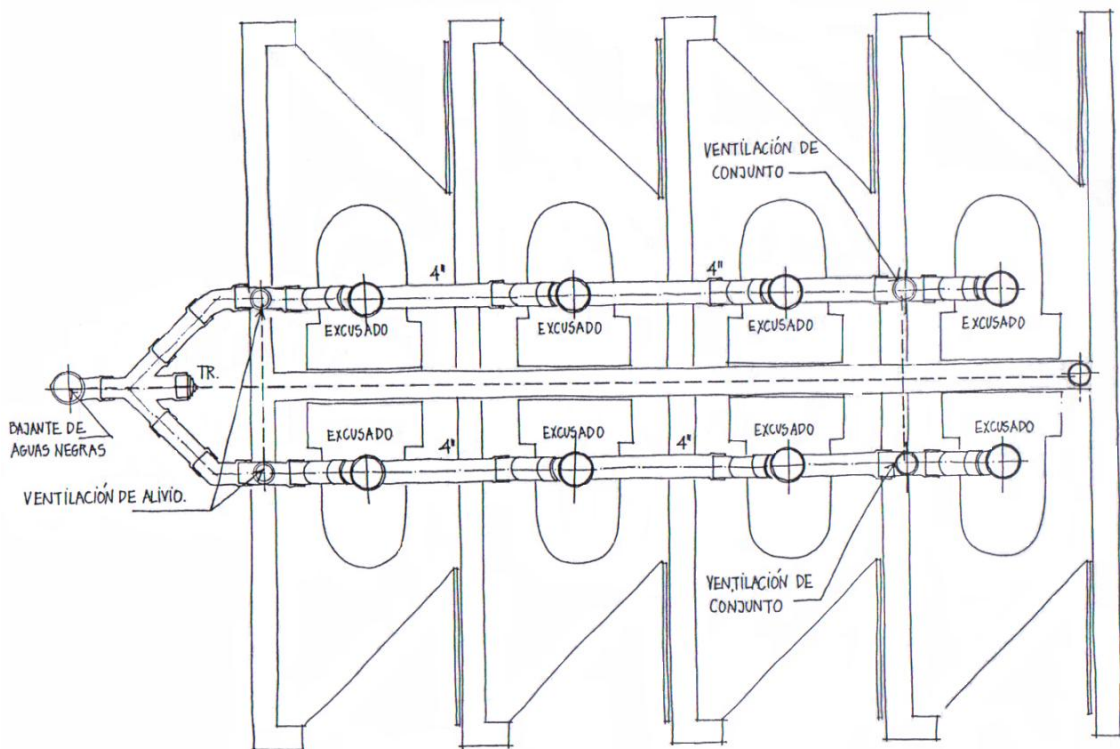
Ventilación en Conjunto para ramales paralelos - Planta
